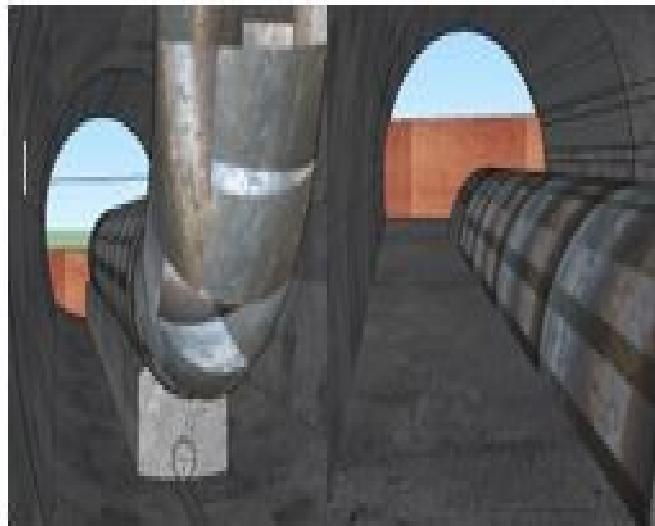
68 Ilustrasi Pembetonan Plugging
